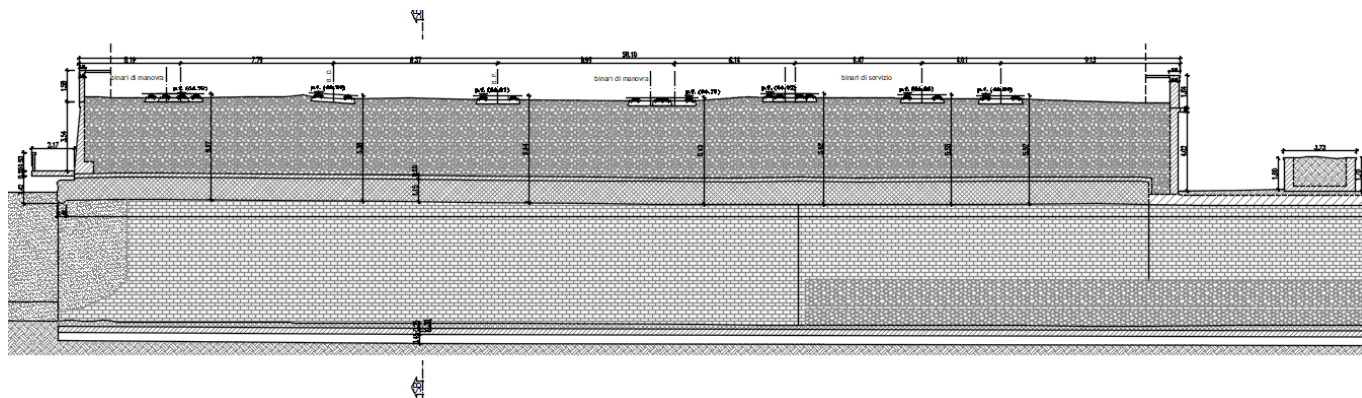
Sezione longitudinale Ponte Camuzzoni
